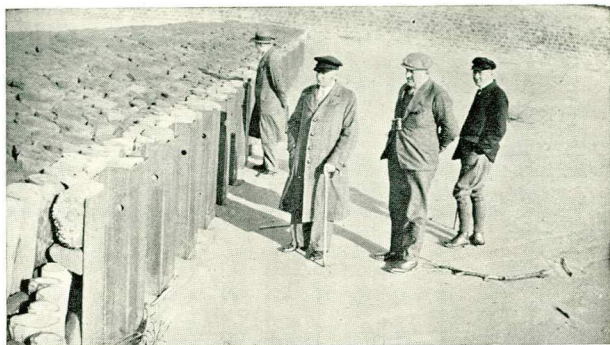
Hoofd D 1, zijdelings gesteund door ijzeren damwand Larssen I, lang 4 m.
